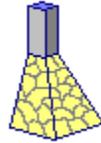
Zapata Aislada, Mampostería, Cuadrada, Sección Variable, Colindante
